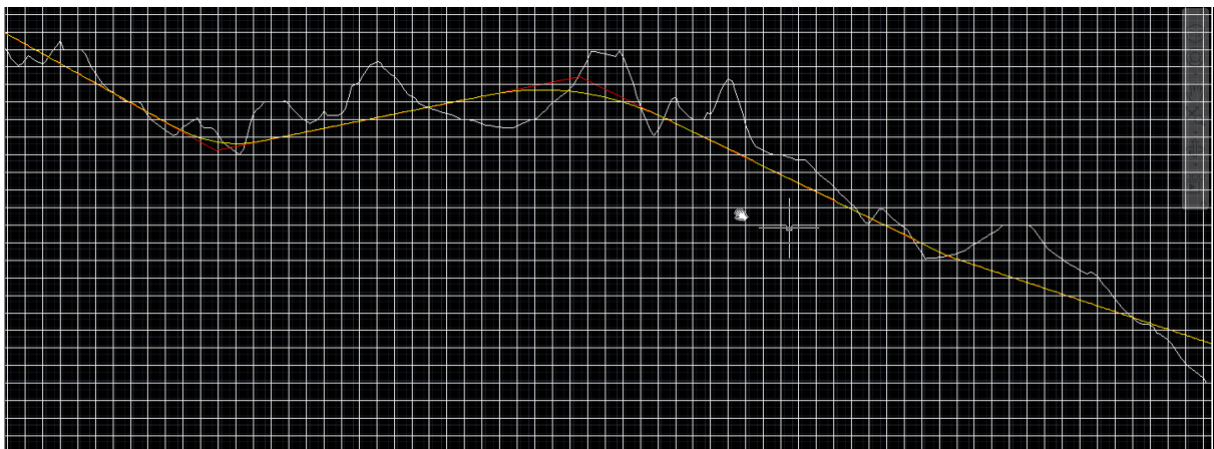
Detalle del perfil longitudinal de la envolvente de máximos.
